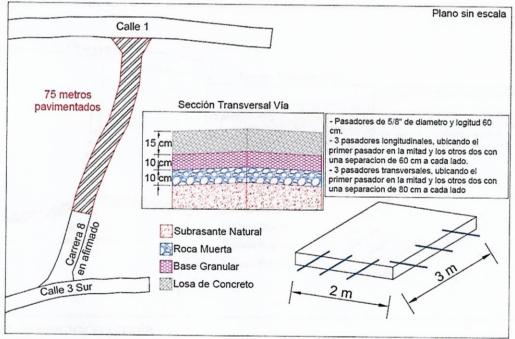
Plano y sección transversal sector El Llanito - Mondomo
